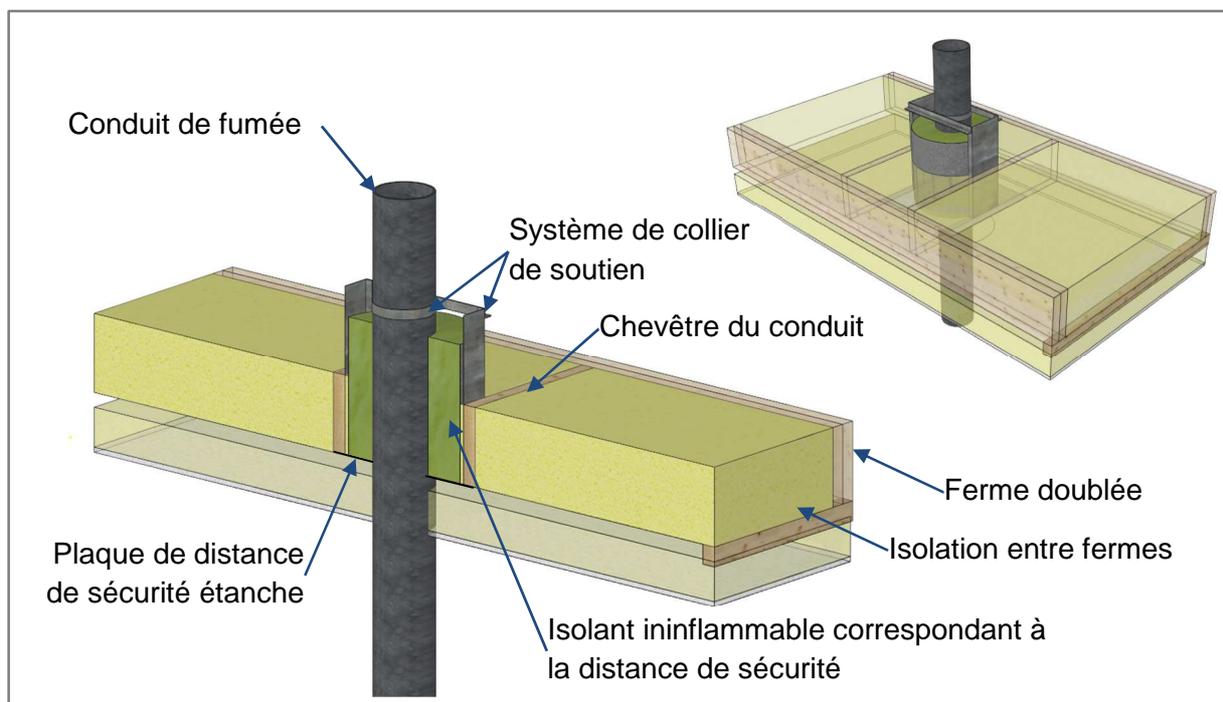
Exemple de système de gestion des ponts thermiques et de l'étanchéité à l'air lors de la traversée de toiture ou de plancher par un conduit métallique
